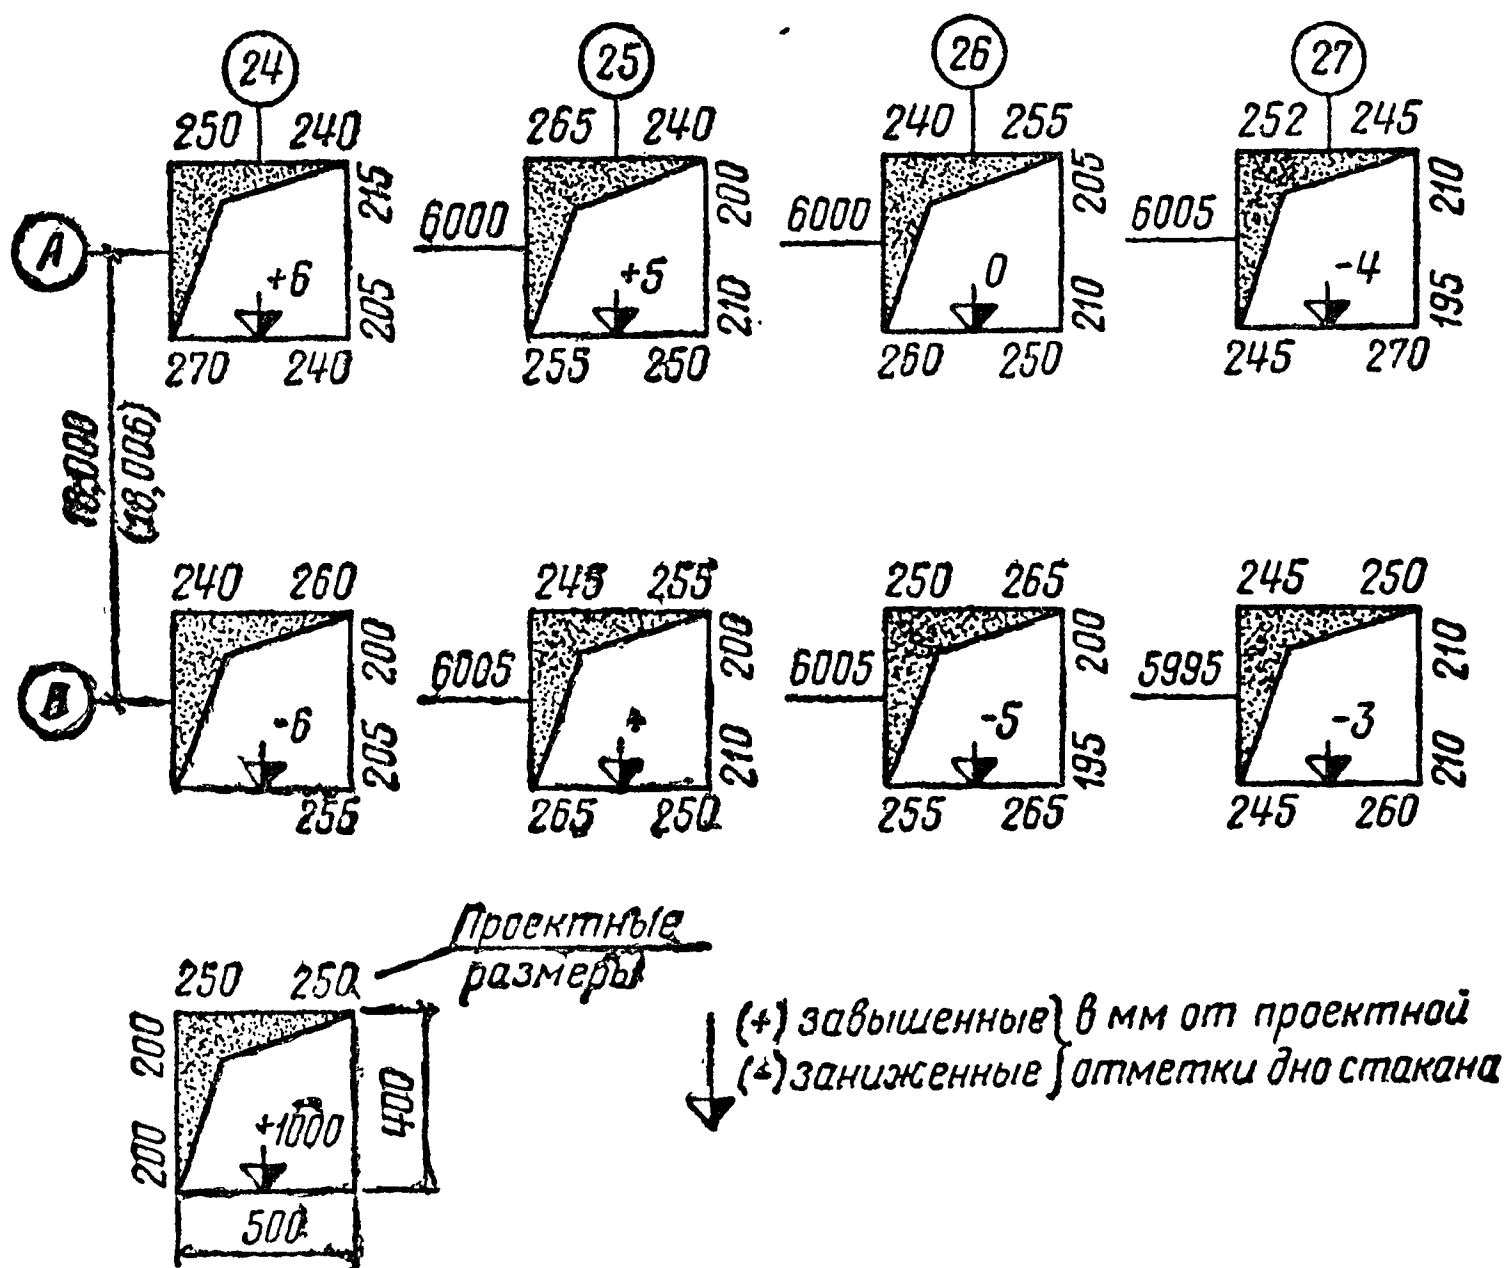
Исполнительная схема монтажа сборных фундаментов
